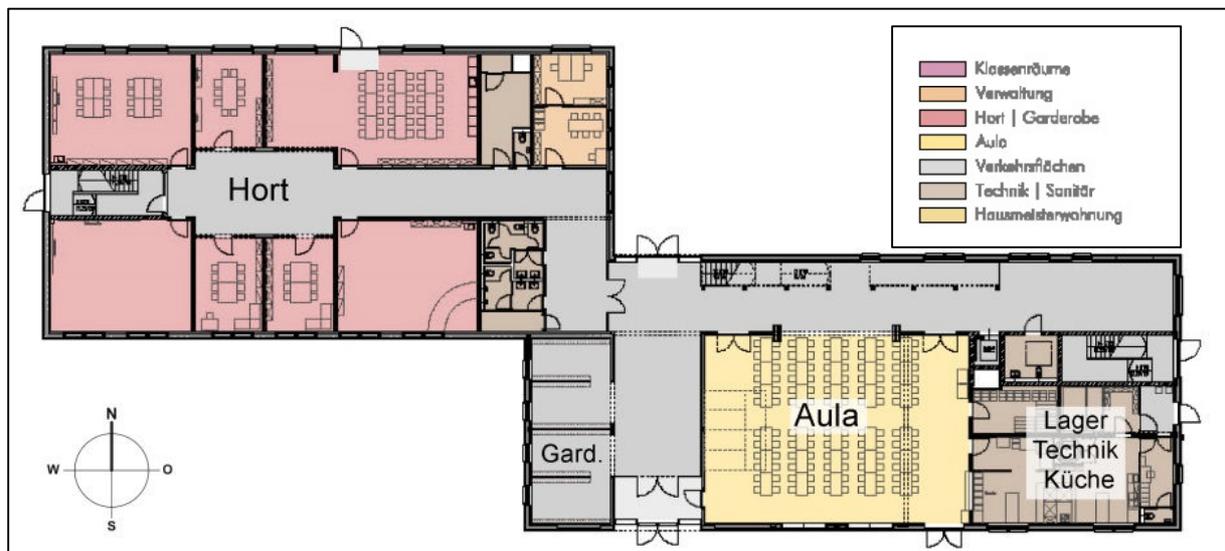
Grundriss EG mit Nutzung [3]
